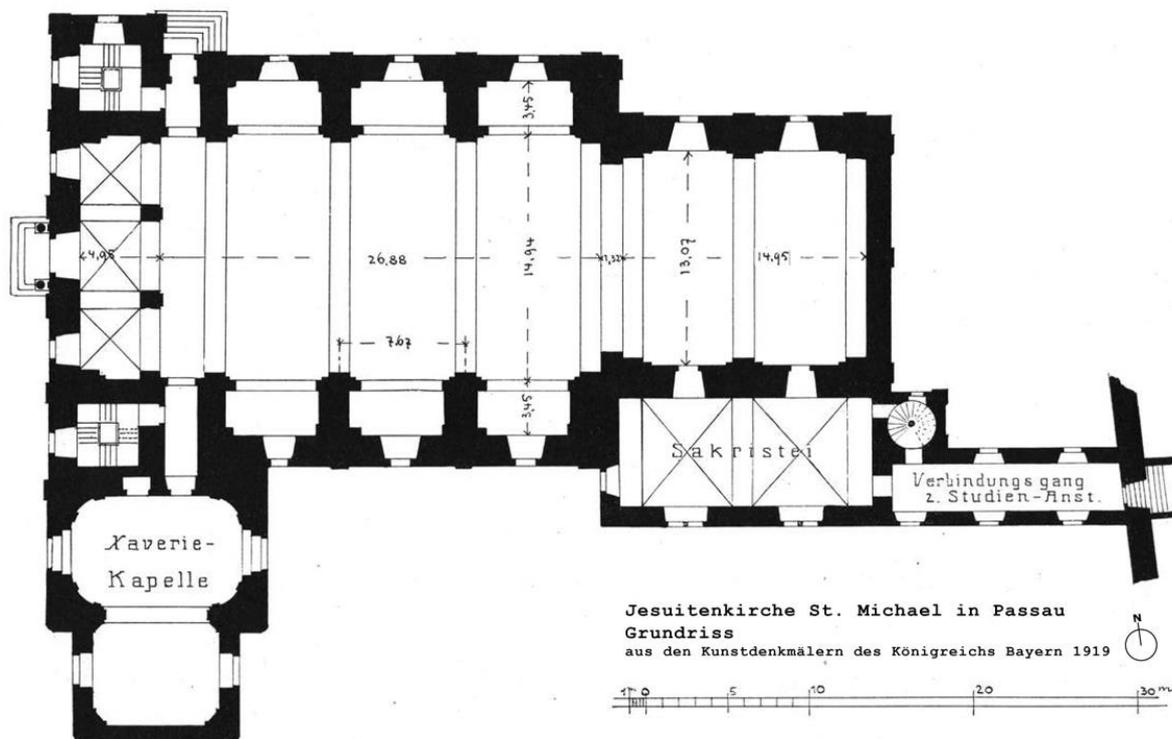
Passau, ehemalige Jesuitenkirche St. Michael, „Carlone-Schema“, Grundriss nach Bieri
